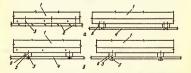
Схемы крепления шпунтованных досок к балкам перекрытия (а) и плит к каркасу из реек (б):
